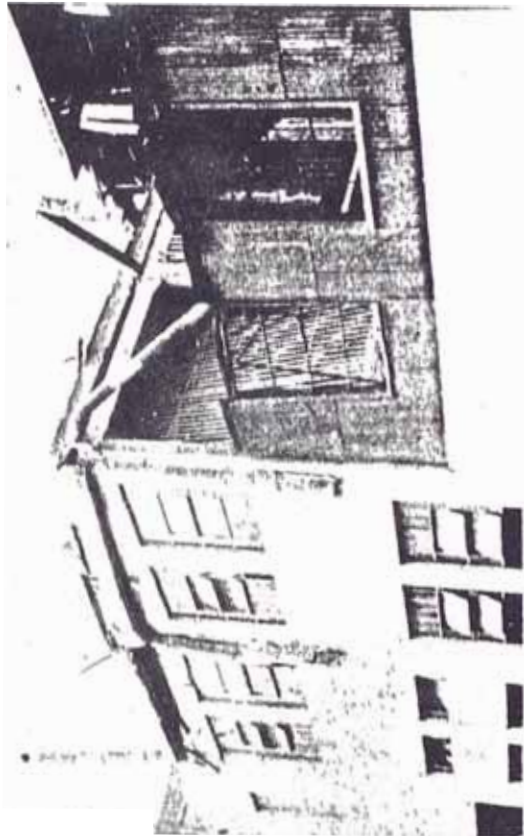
Lima, 1940. Edificio auxiliar de la Cía Nacional de Cerveza. Obsérvese algunas de las columnas del tercer piso, colgando de sus aceros de refuerzo y las vigas del techo de la planta superior del edificio, descansando sobre su piso.
